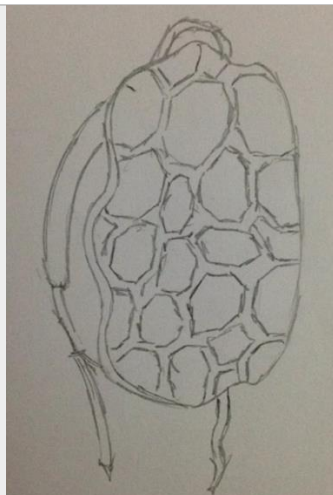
Boceto pavimentación. Fuente: Autoría propia
